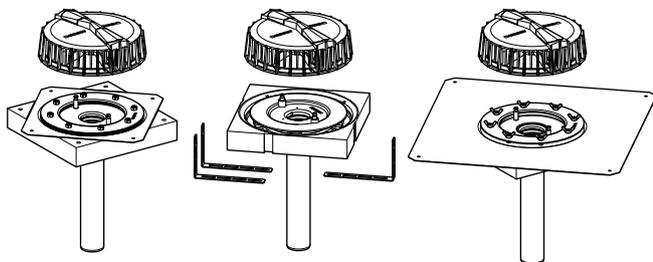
Geberit Pluvia Dachwassereinläufe 12 l
